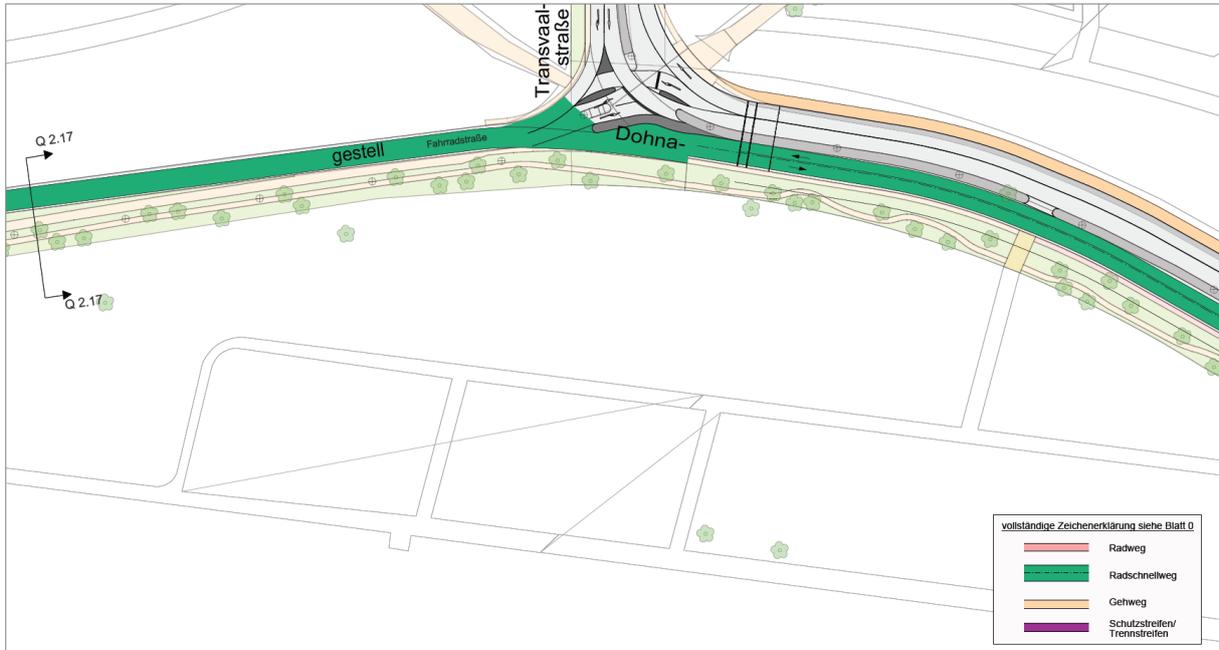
Knotenpunkt Dohnagestell/Transvaalenstraße mit gesonderter RSV-Führung
